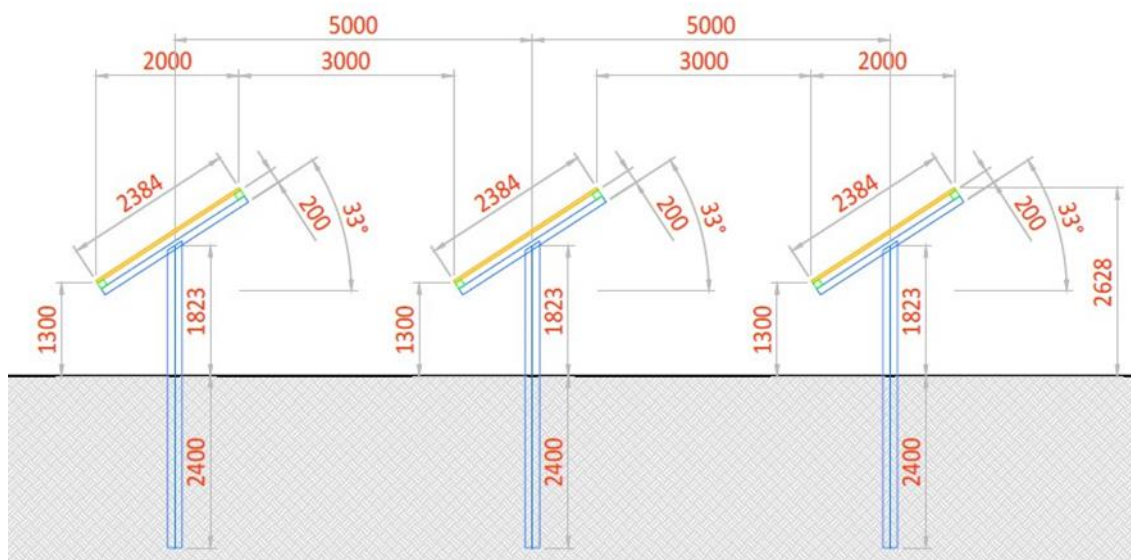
Particolare costruttivo struttura fissa ed esempio di struttura fissa
